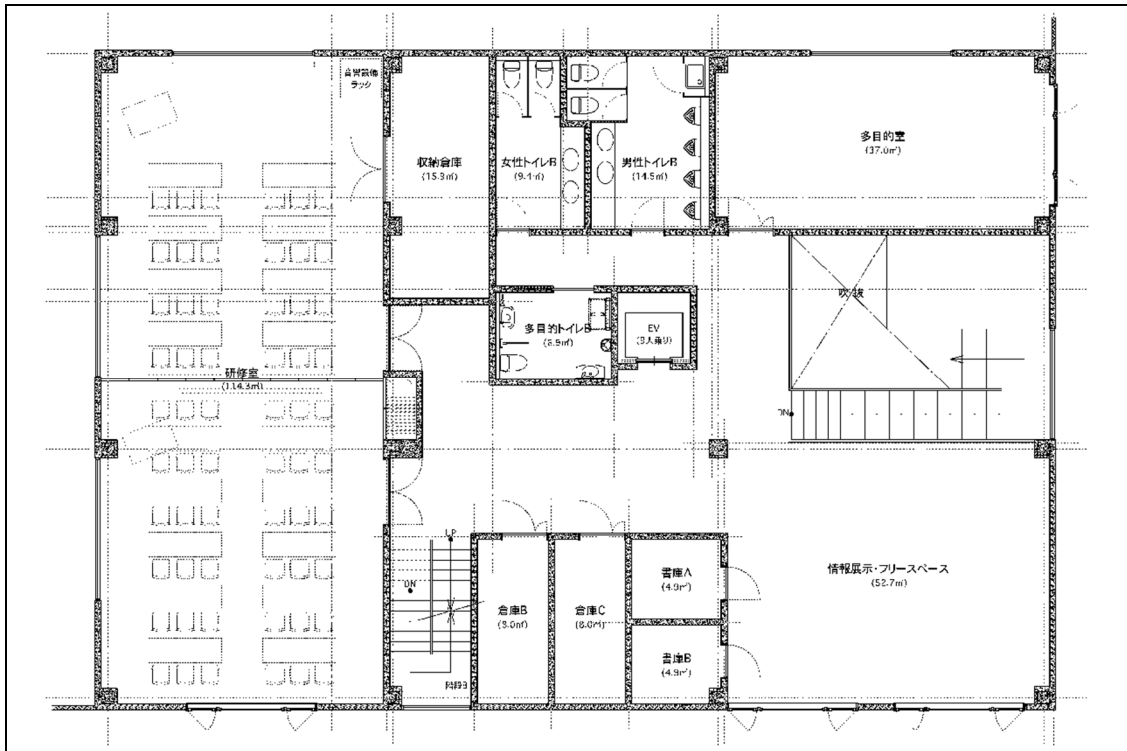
浸出水処理施設・管理事務所部（2階平面図）
